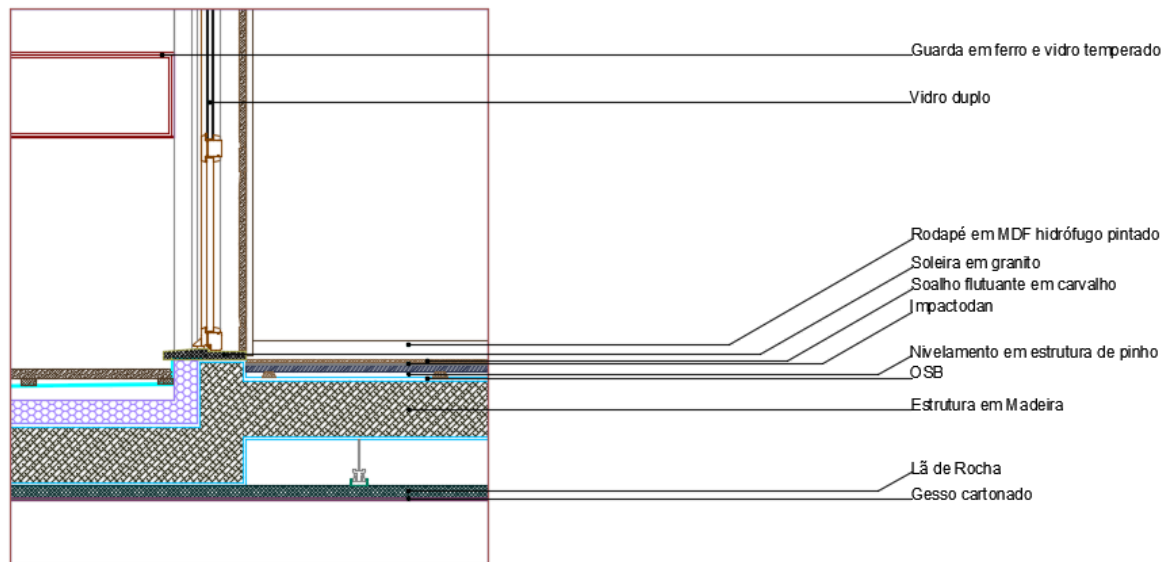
Constituintes previstos para pavimentos interiores, com pormenor de guarda de varanda.
